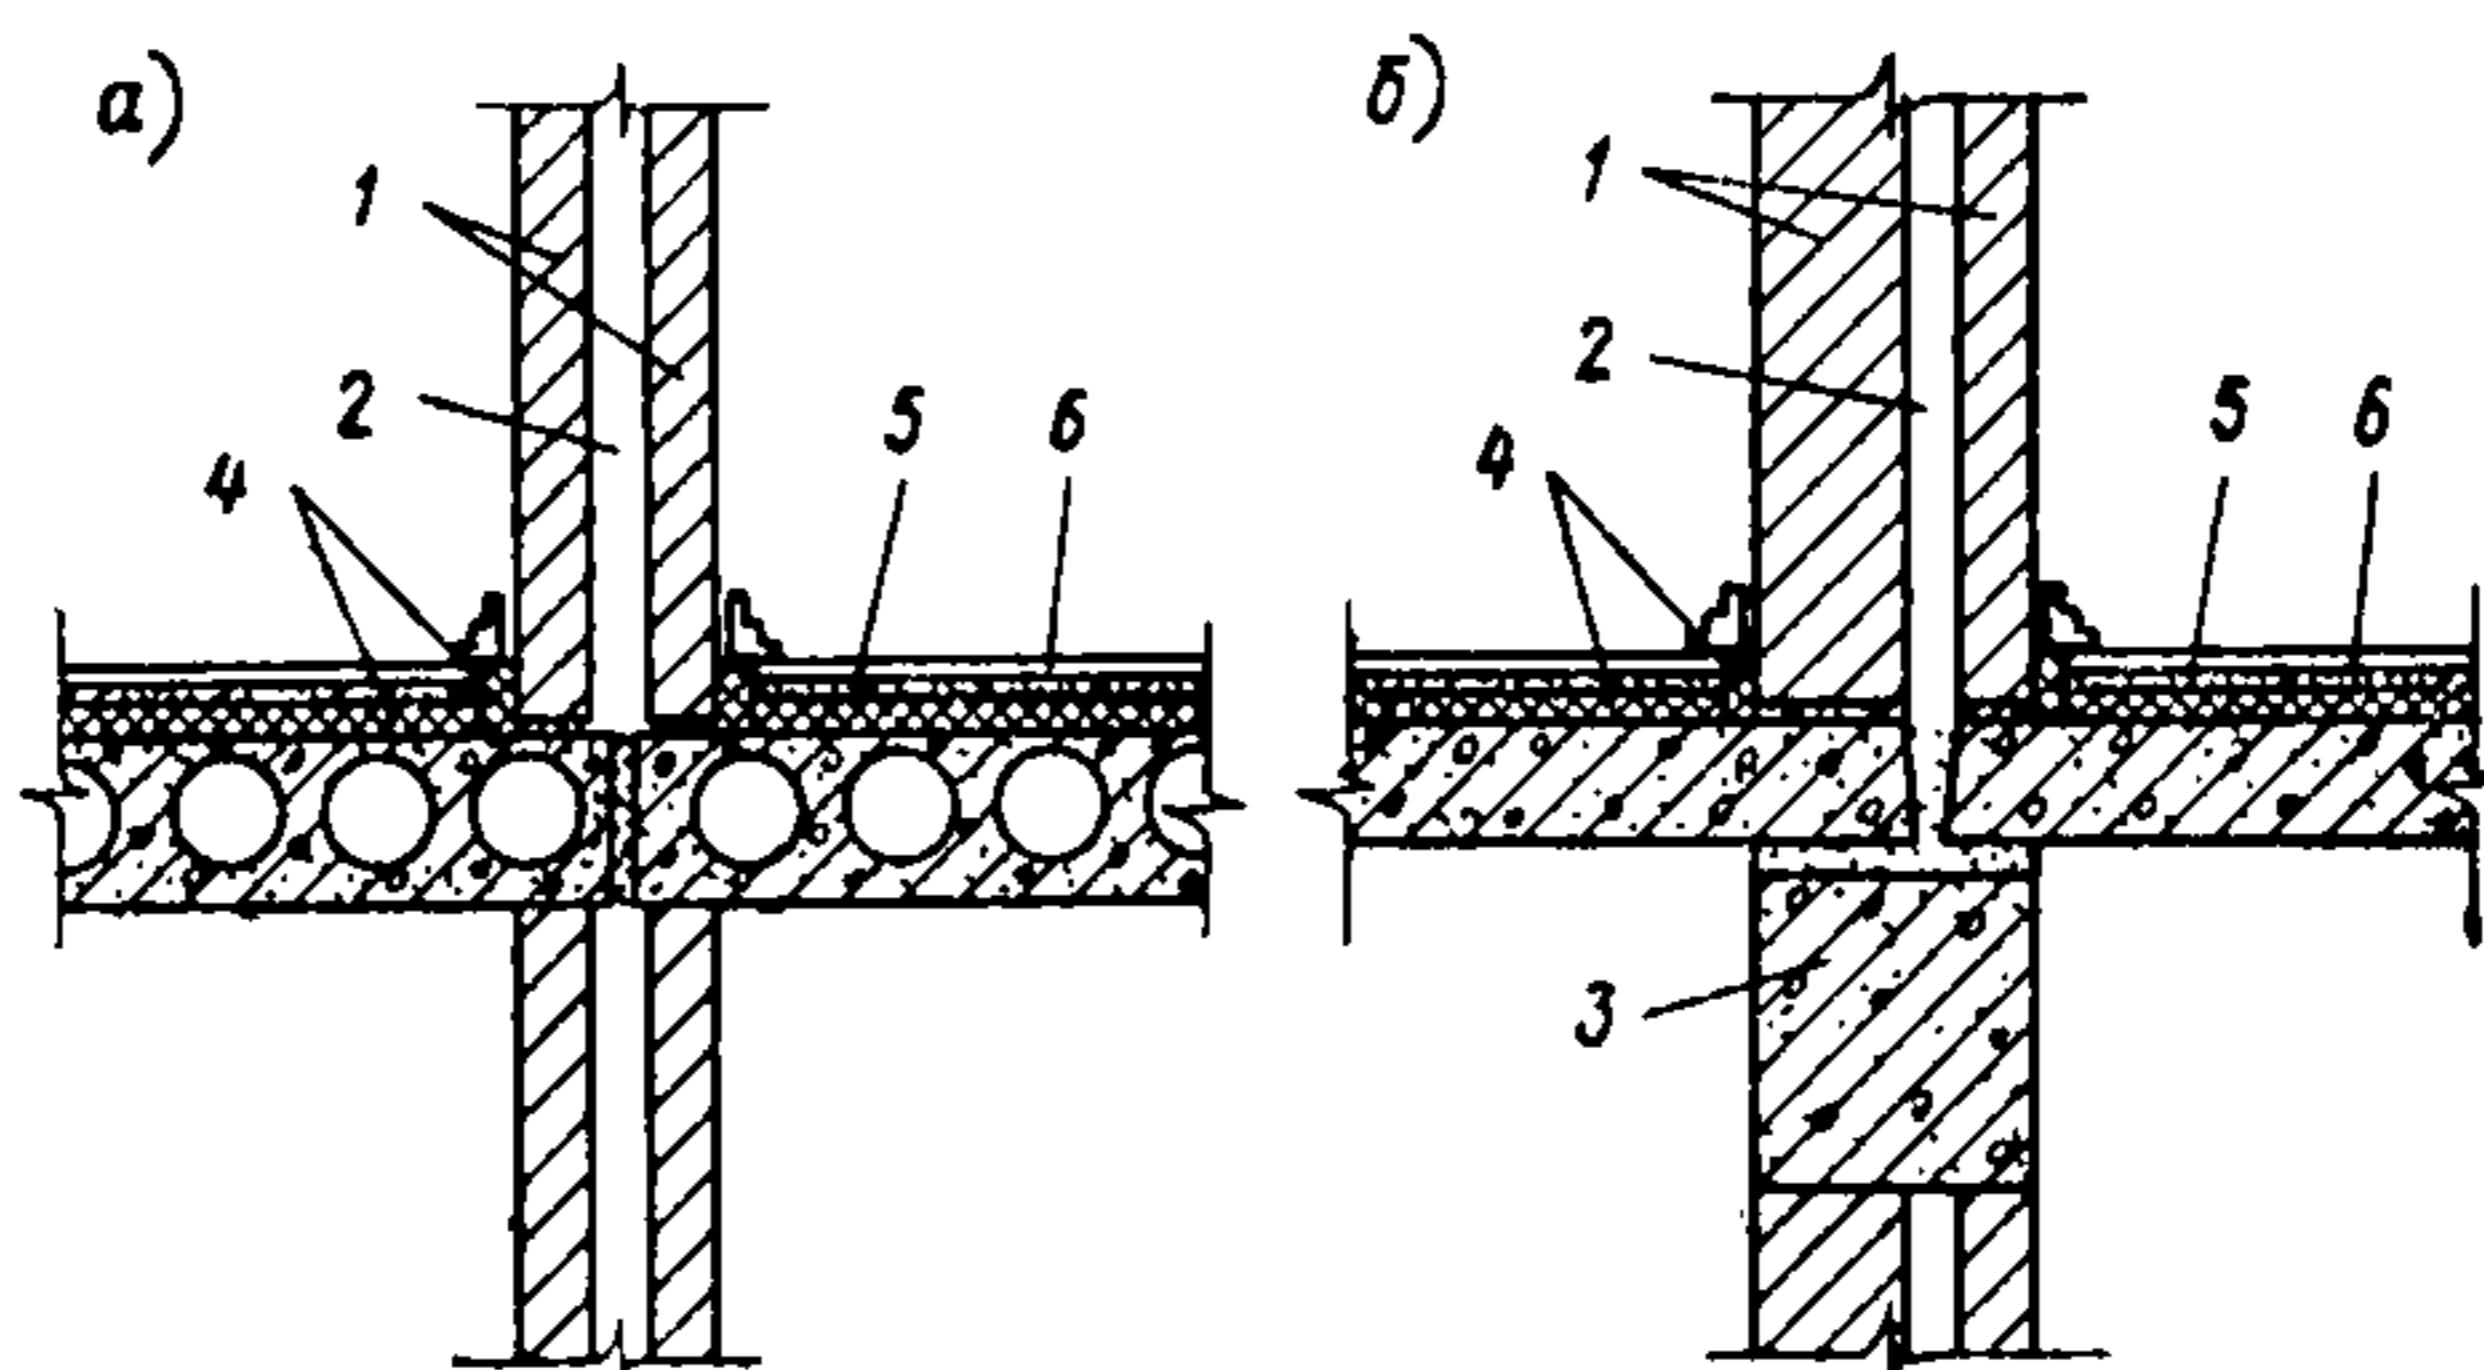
Схема установки перегородок со сплошным воздушным промежутком
